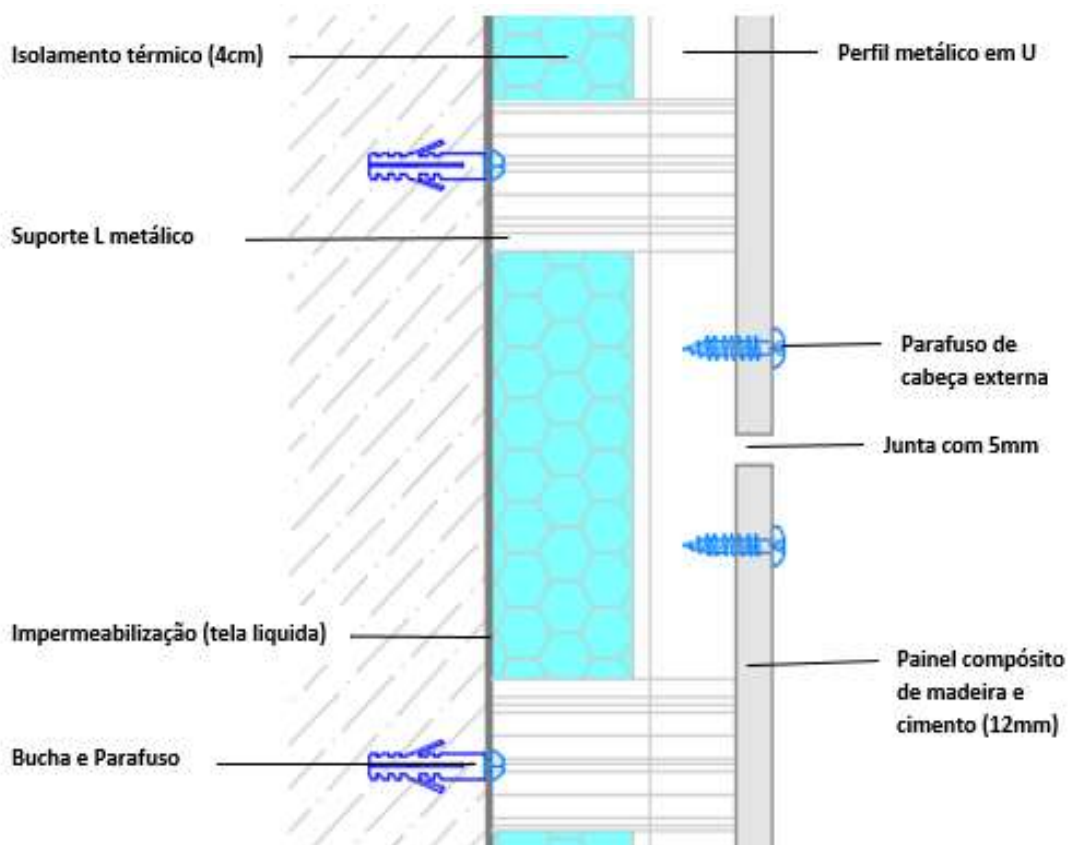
Seção vertical na aplicação em fachadas ventiladas
